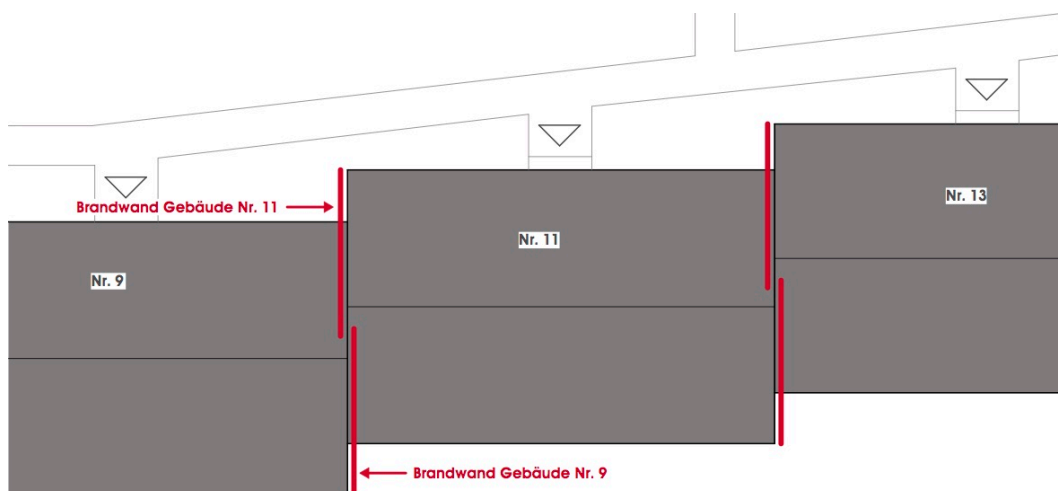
schematische Darstellung Lage Brandwand: Ausschnitt Gebäudezeile, ohne Maßstab, bauart Architekten
